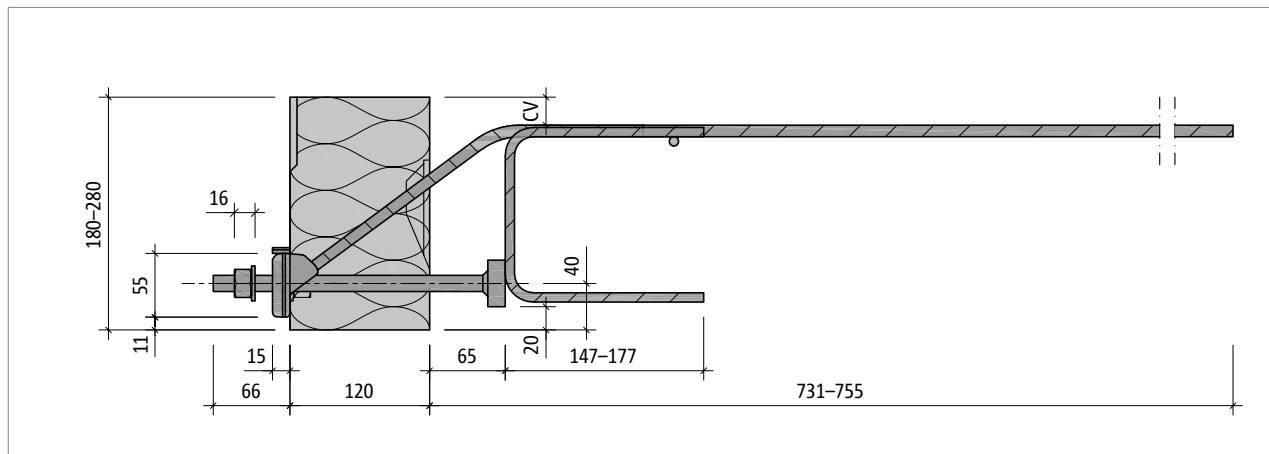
Schöck Isokorb® XT type SQ-V2 : vue en coupe du produit
